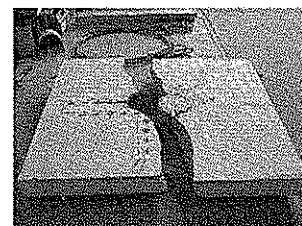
最終破壊状況 (ひび割れ注入工ケース: case.3)
